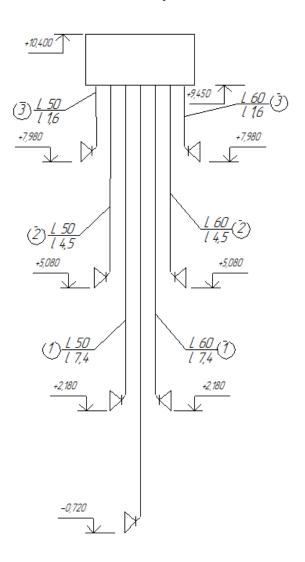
Расчётная схема вытяжной вентиляции
